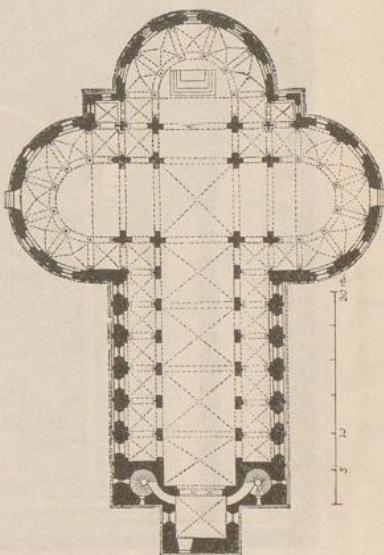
Grundriss von St. Maria auf dem Capitول zu Köln.
